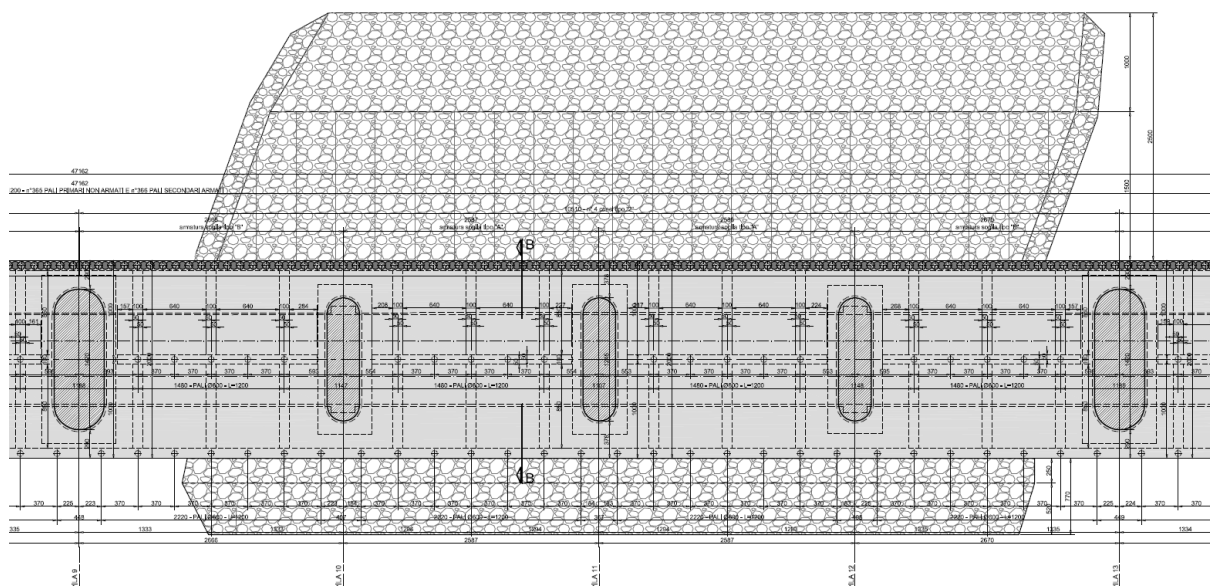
Scivolo di protezione in pietrame –Stralcio Planimetrico
